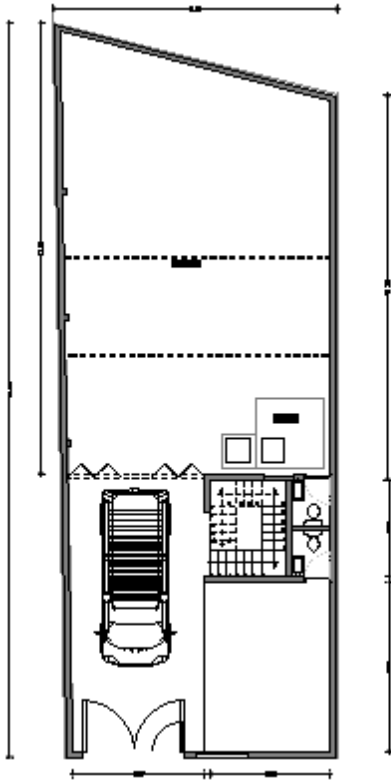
Planta baja de proyecto arquitectónico de adecuación (bodega). Autoría propia.
